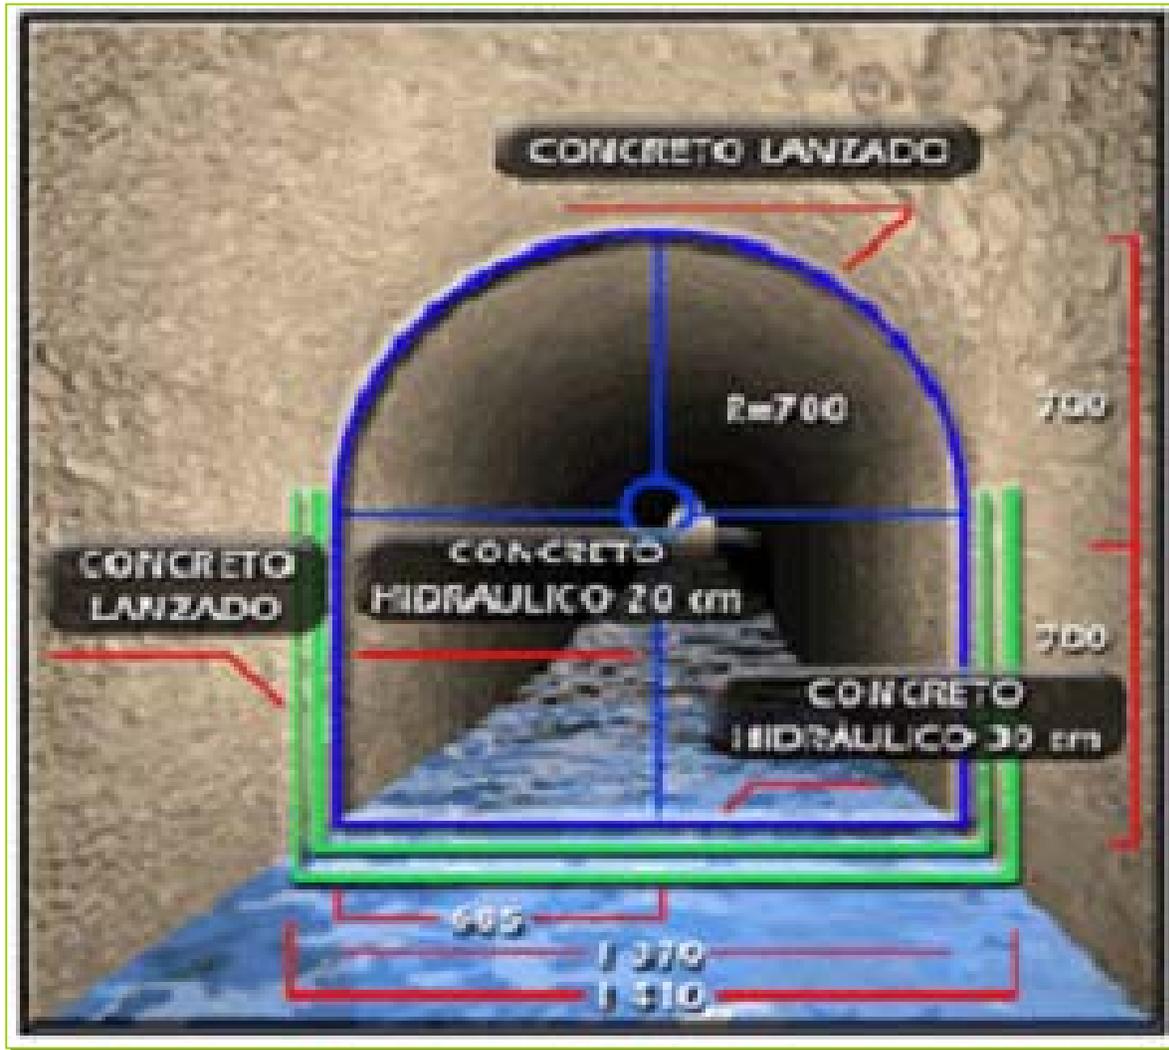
CONCRETO HIDRAULICO Y LANZADO EN PISO, MUROS Y BOBEDA.
